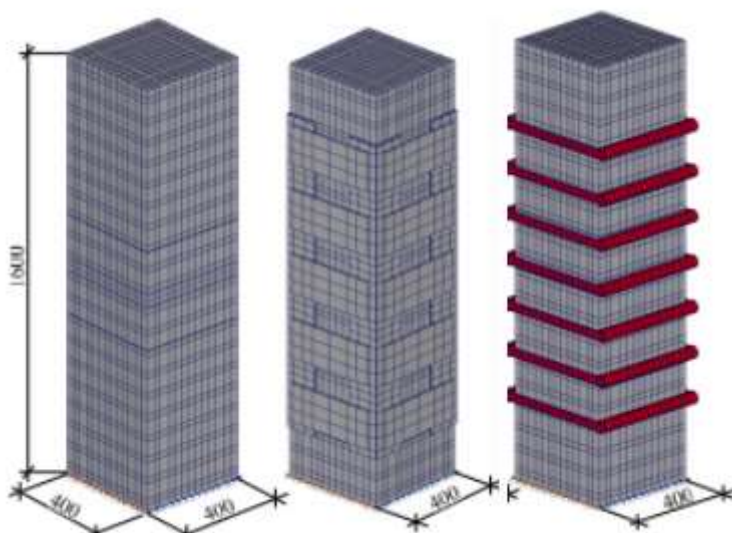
Расчетные схемы железобетонных колонн: без усиления, усиленной металлическими обоймами из уголков с планками и П-образных элементов из арматурной стали соответственно
